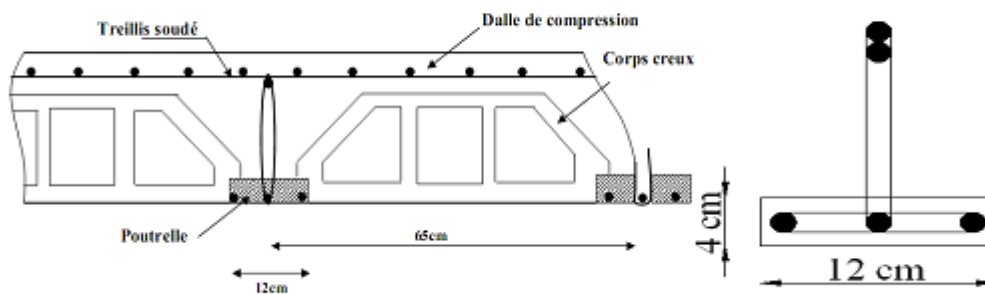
Coupe verticale d'un plancher en corps creux. Figure III.5.2 : poutrelle.
